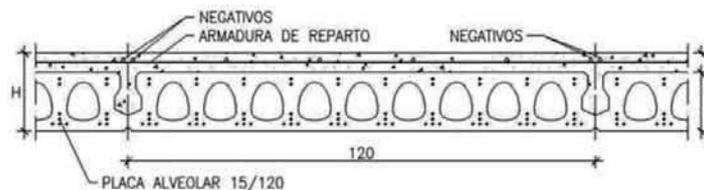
Forjado de placas alveolares sobre muro de bloque de hormigón hueco. Sección transversal con placas alveolares.
